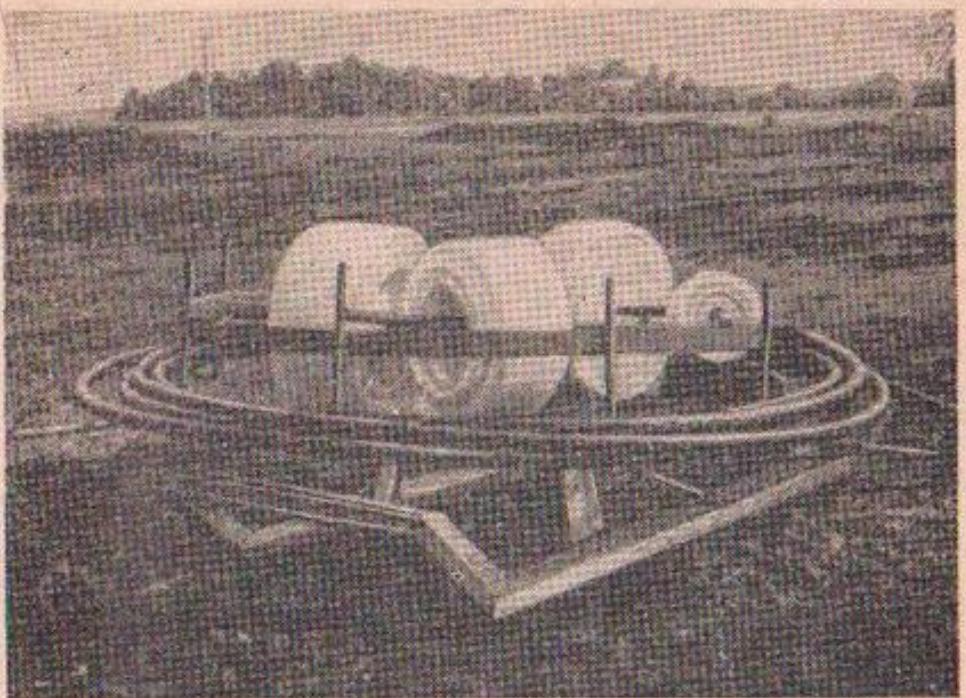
Сани с горизонтальным барабаном для прокладки пластмассовых труб.
